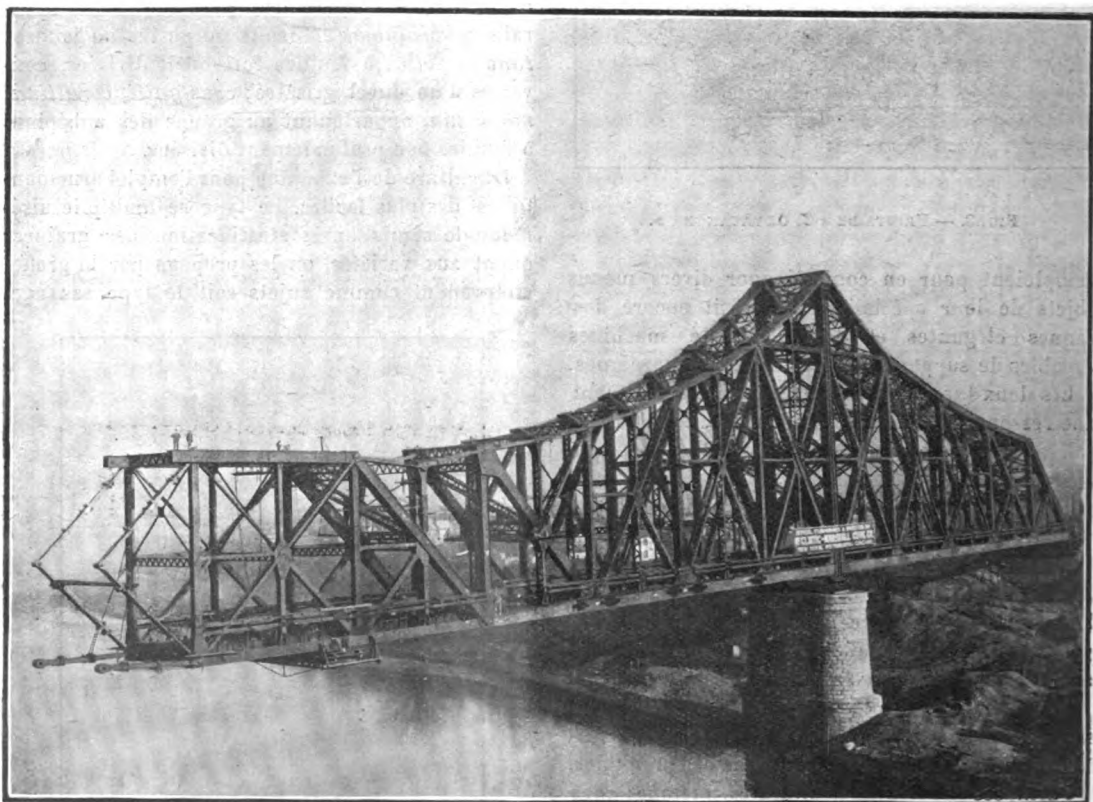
CONSTRUCTION DU PONT MÉTALLIQUE SUR L'OHIO, A BEAVER. AVANCEMENT DE LA VOLÉE SUR LE VIDE.
